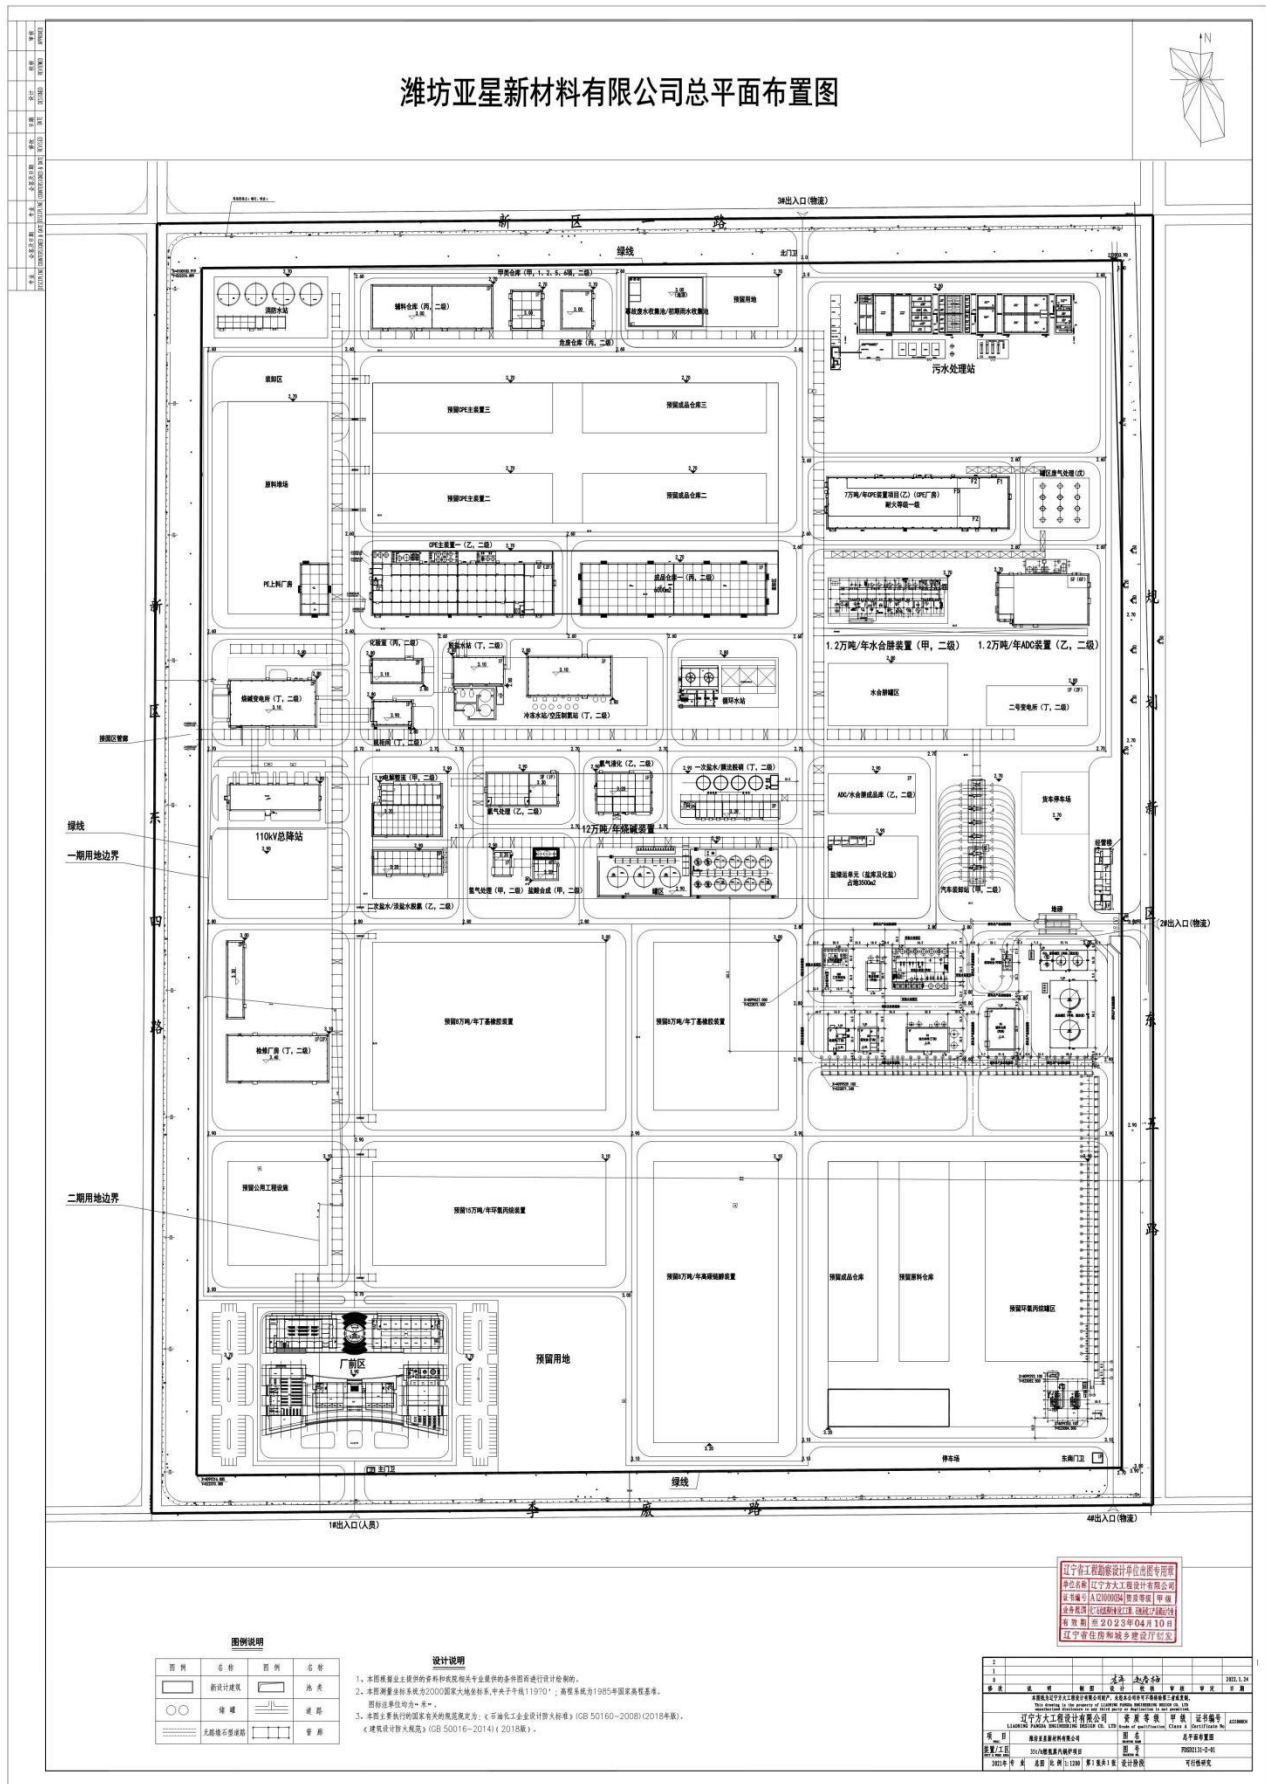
潍坊亚星新材料有限公司平面布置图 1:1200
